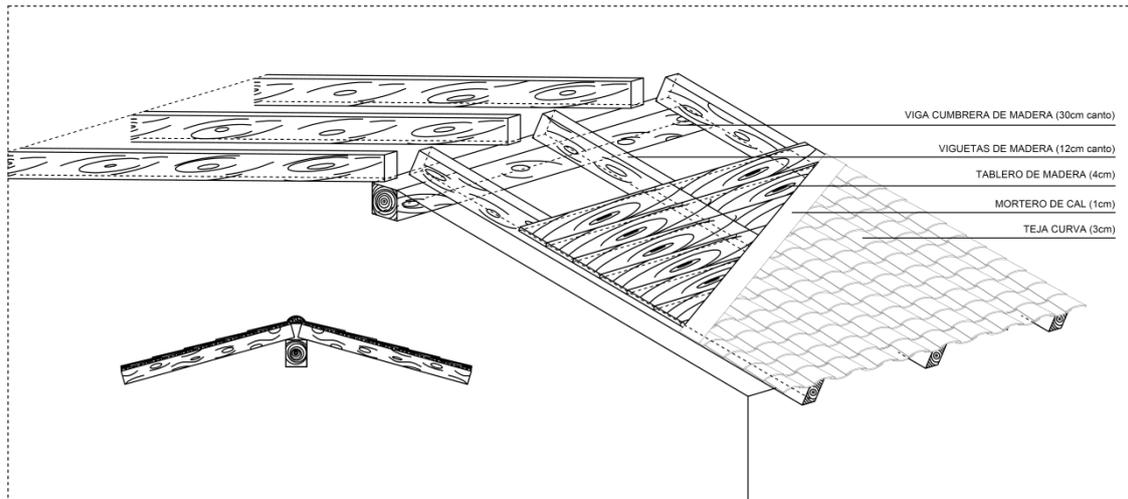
Detalle constructivo de la cubierta con estructura de madera y recubrimiento de teja cerámica
